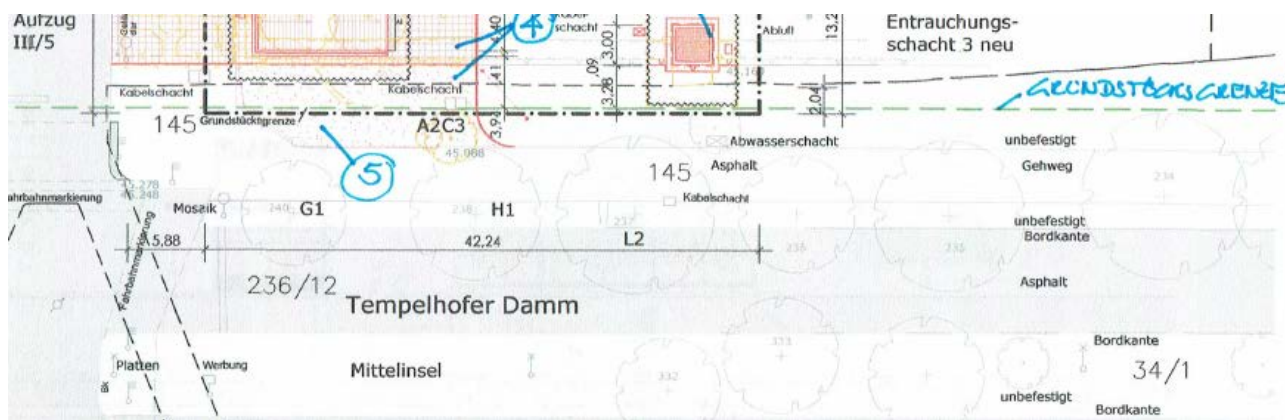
Auszug aus Plan mit Angaben zur Lage der Fläche
